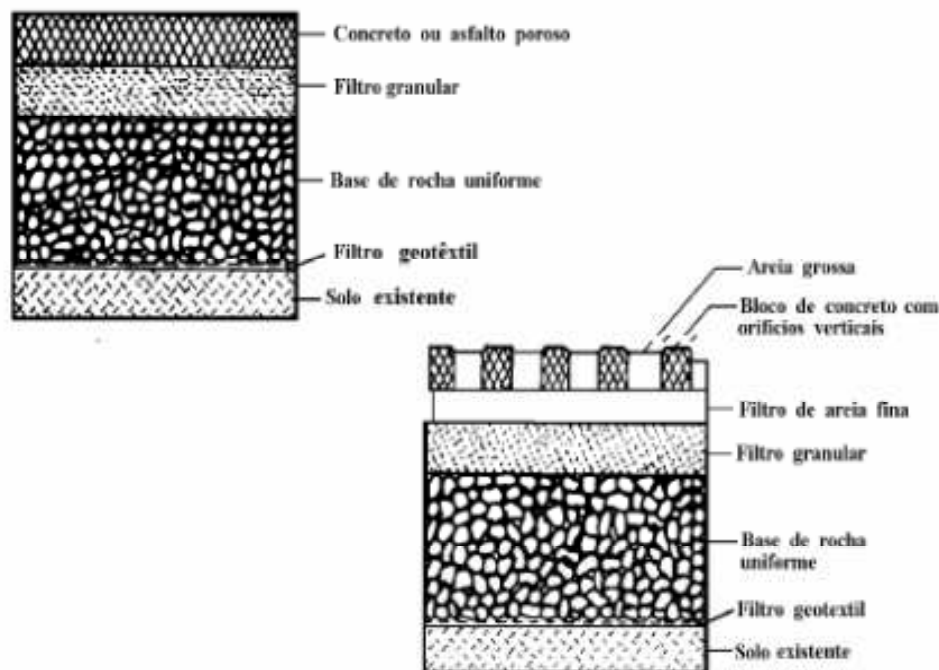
Camadas dos pavimentos permeáveis (URBONAS & STAHR, 1993)
